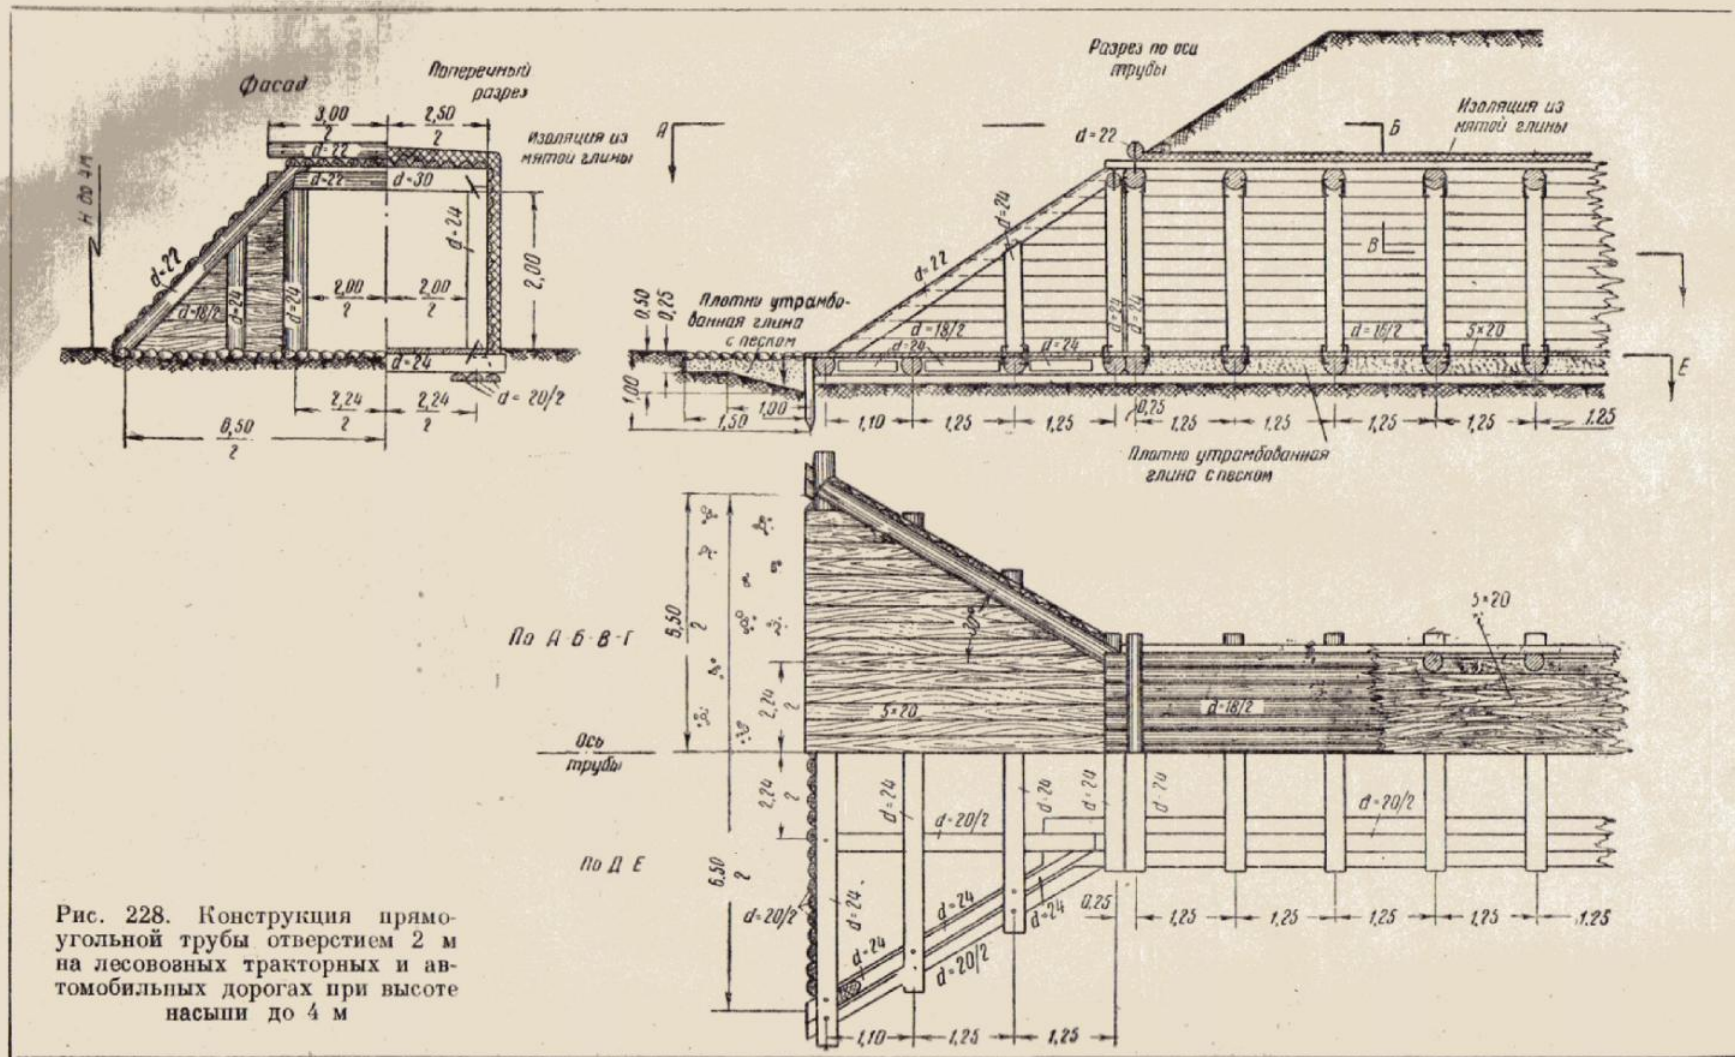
Конструкция прямоугольной трубы отверстием 2 м на лесовозных тракторных и автомобильных дорогах при высоте насыпи до 4 м
